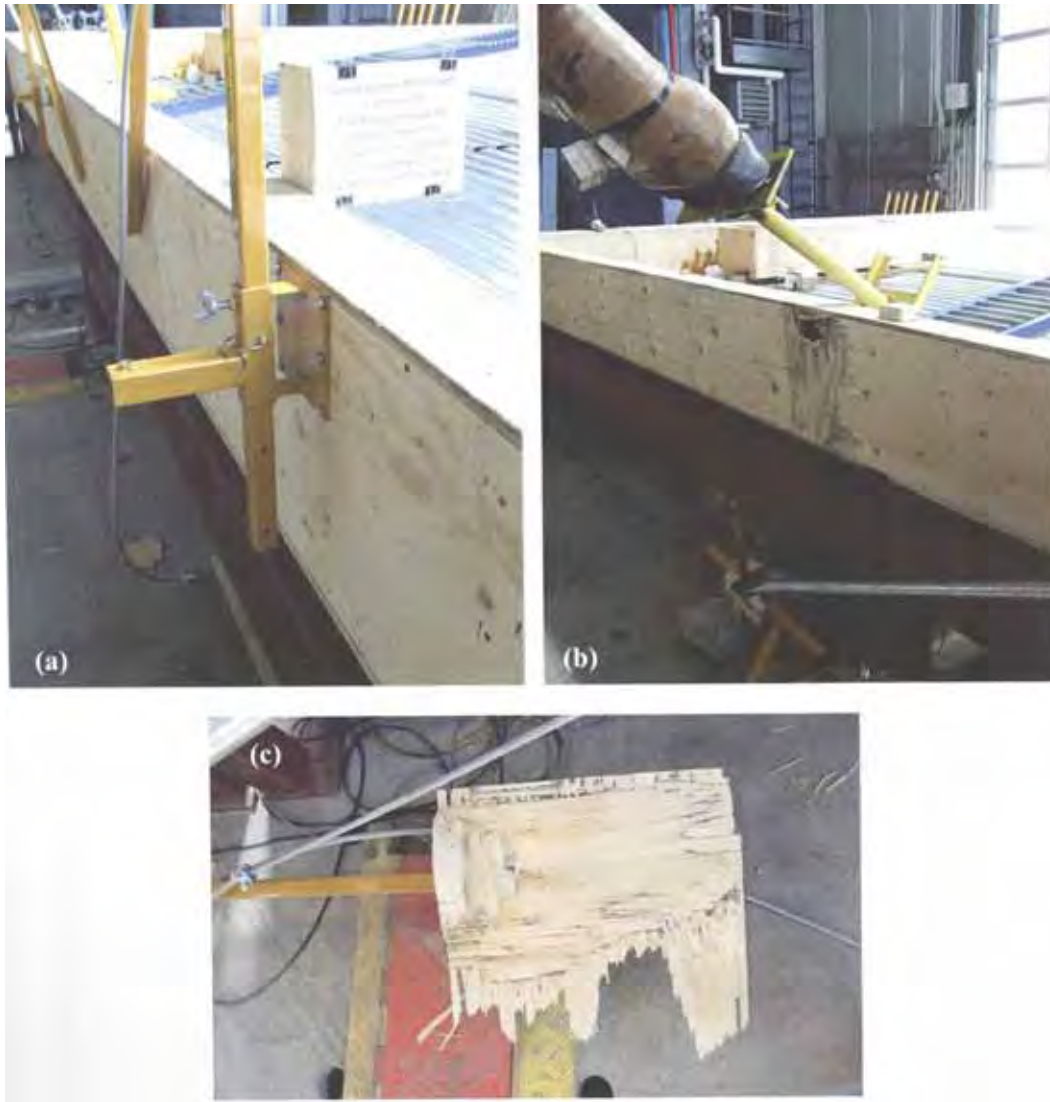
Essai GC-Mal-DYNR-2m-IM-01 sans stabilisateur de poteau :
